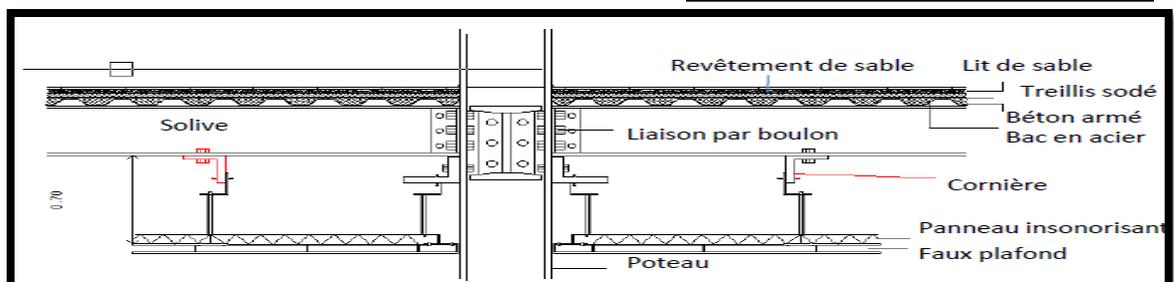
schéma de jonction poteau-plancher/ Source : les auteurs.
